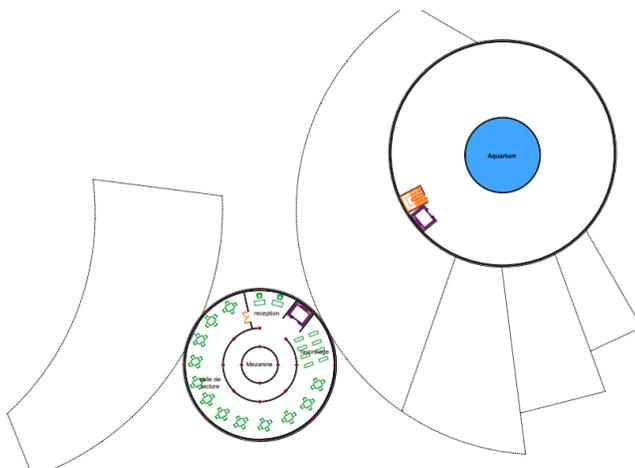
plan 3 ème étage. (Source: auteur,2021)
